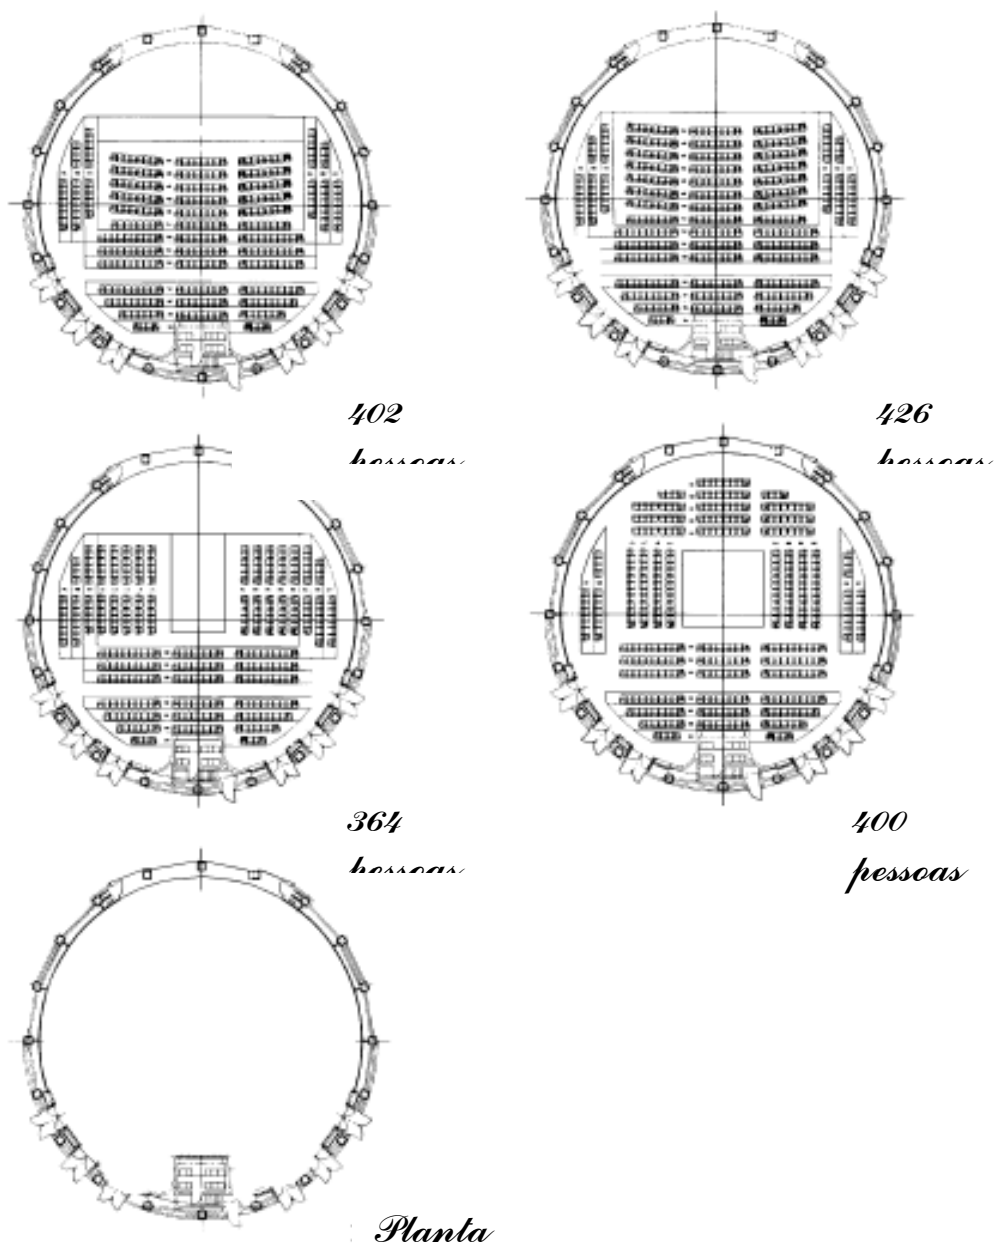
Flexibilidade de layout do Orbis Hall, Kobe, Japão.
